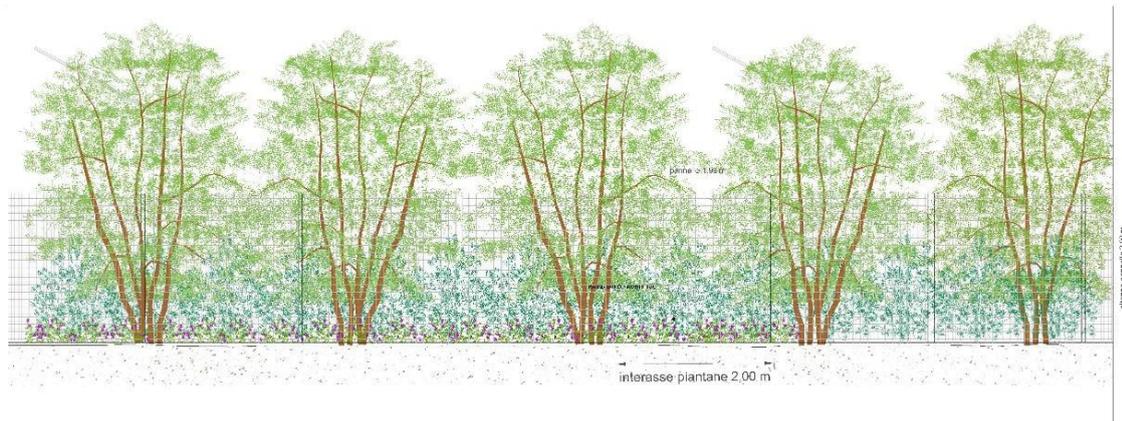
Prospetto recinzione perimetrale con mitigazione
